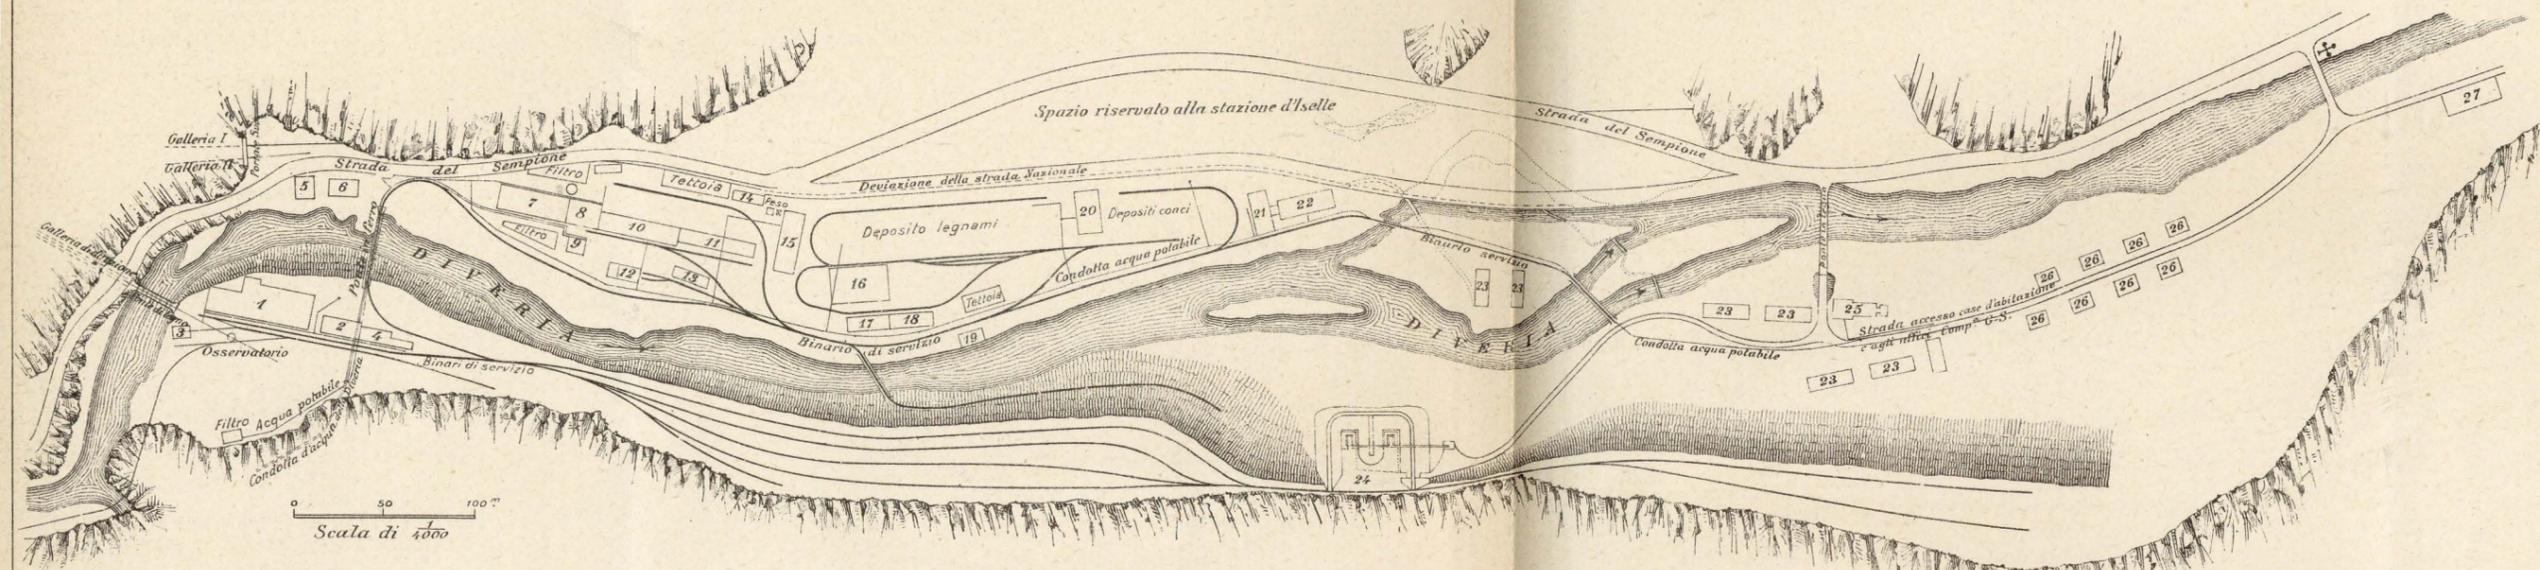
Planimetria generale del cantiere di Iselle — Scala di 1: 4000.
